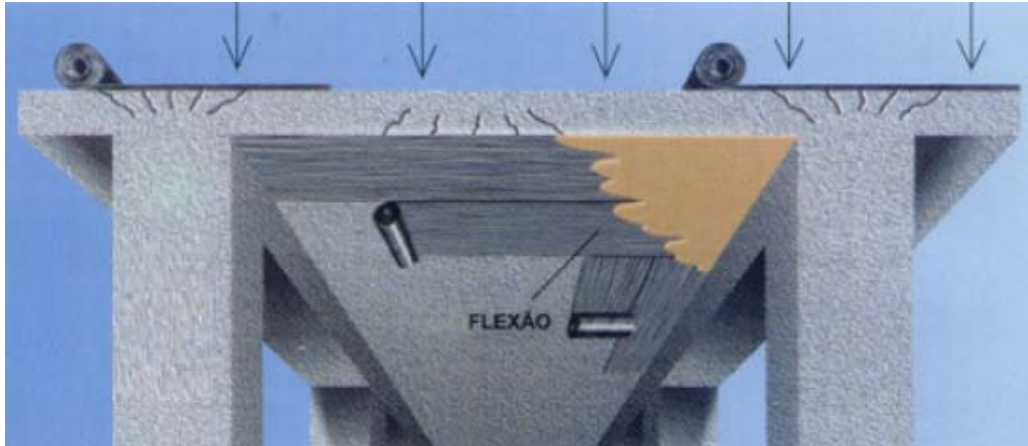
Aplicação do CFC nas regiões tracionadas da laje; www.masterbuilders.com.br, visitado em 2006.
